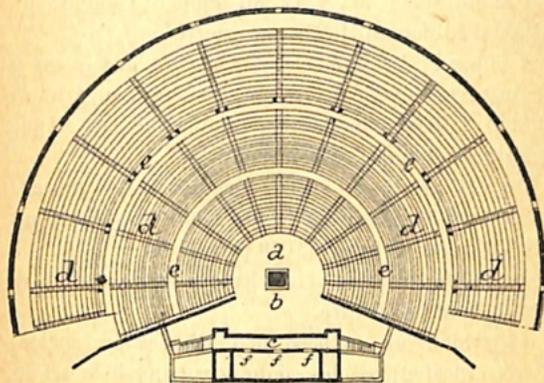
Restauration du plan du théâtre d'Épidaure.
